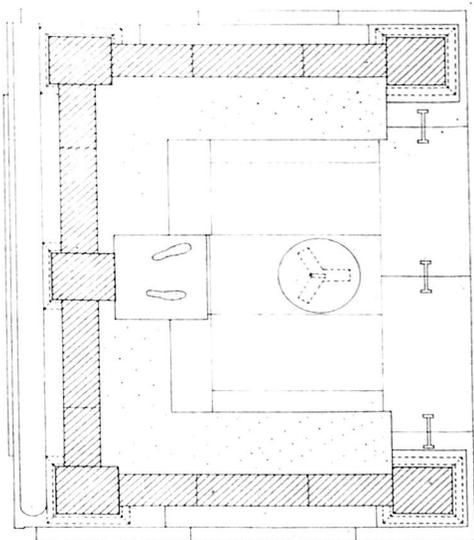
Épidaure. Exèdre d'Aristarchos. Ci-dessus. Plan d'ensemble restauré. A gauche, en haut, plan de la plateforme reconstituée ; en bas, plan du degré du socle reconstitué. Échelle 1 : 50. Façade au Nord.
